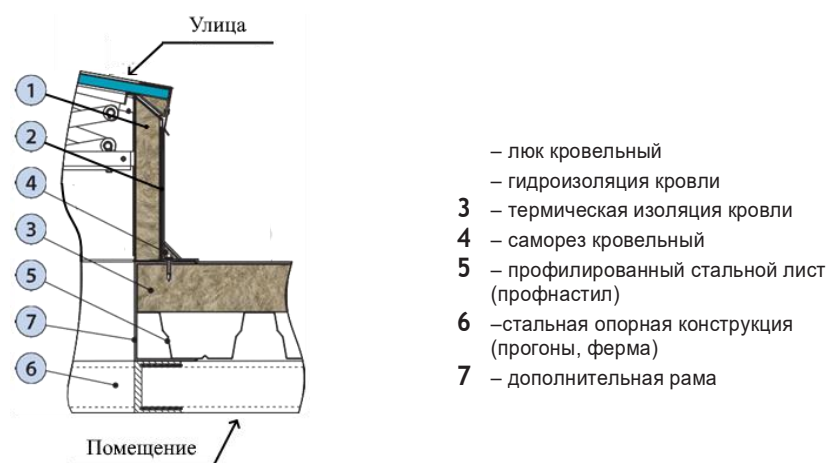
Рекомендуемая схема монтажа вариант 4.1
